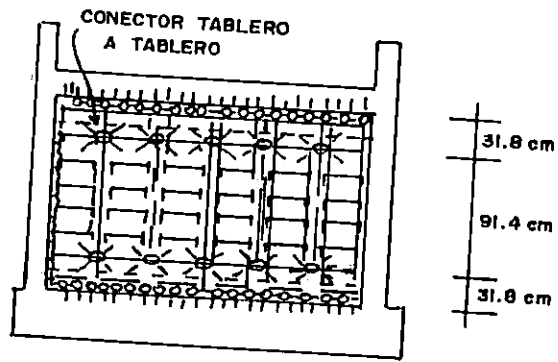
d- MURO DE MULTIPLES TABLEROS PRE-FABRICADOS
